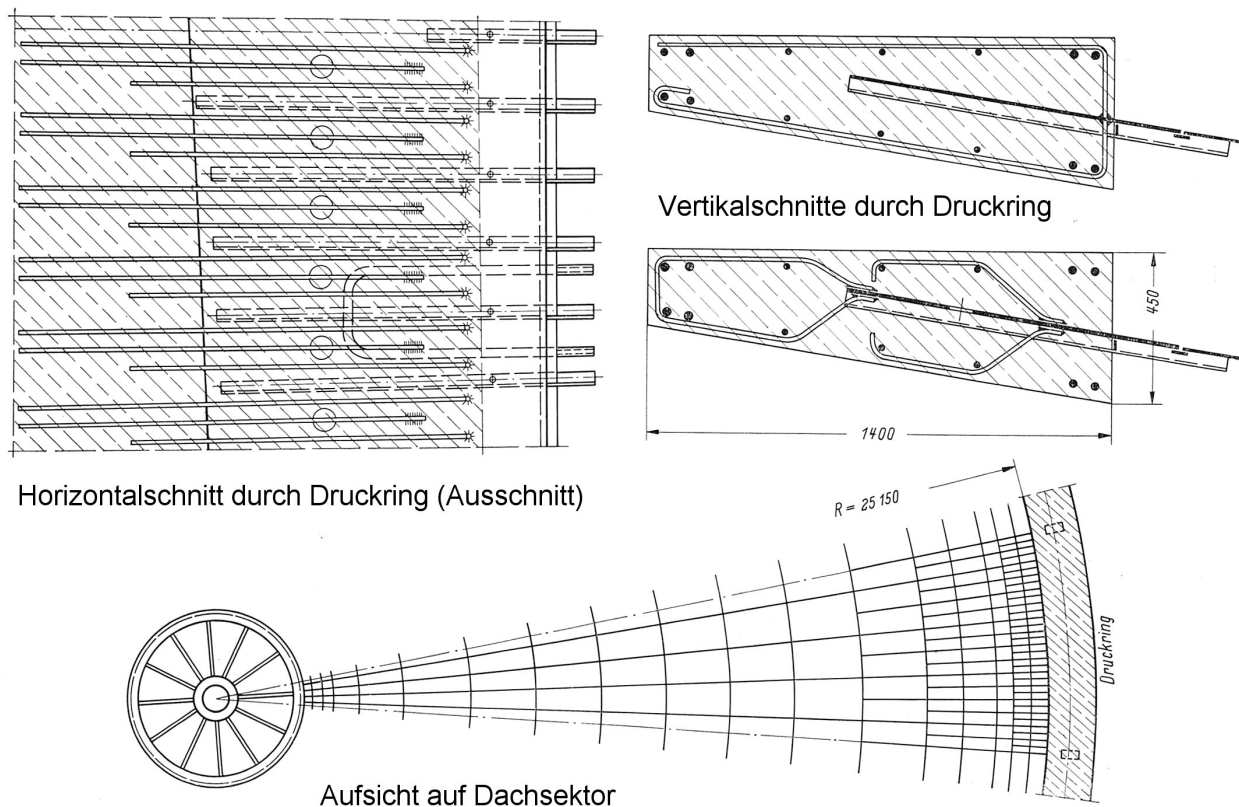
Horizontal- und Vertikalschnitte durch Druckring mit einbetoniertem Anschlussblech (oben), Darstellung eines Dachsektors (unten), Rundhalle Gleisdorf, Ingenieure: Koss, Beer (BNr. 65) [Beer 1963]
